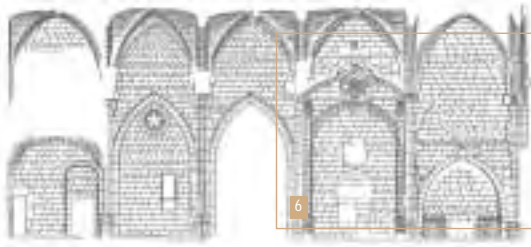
Alzado interior nave norte. Fisuras
